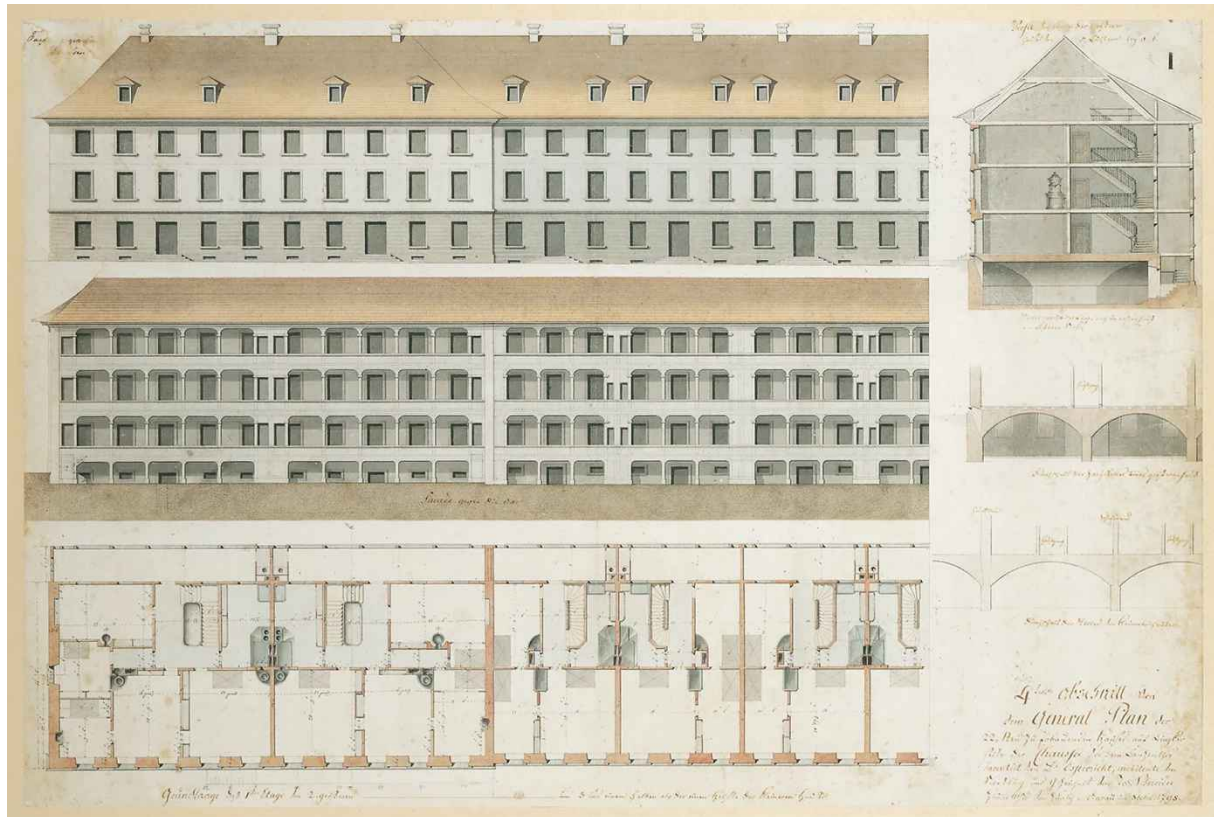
Laurenzenvorstadt, Präsentationsplan von J. Schneider, Oktober 1798. Aufrisse der Strassen- und Gartenfassaden, Grundriss 1. Obergeschoss, Querschnitte. (Stadt im Aufbruch, 124)
